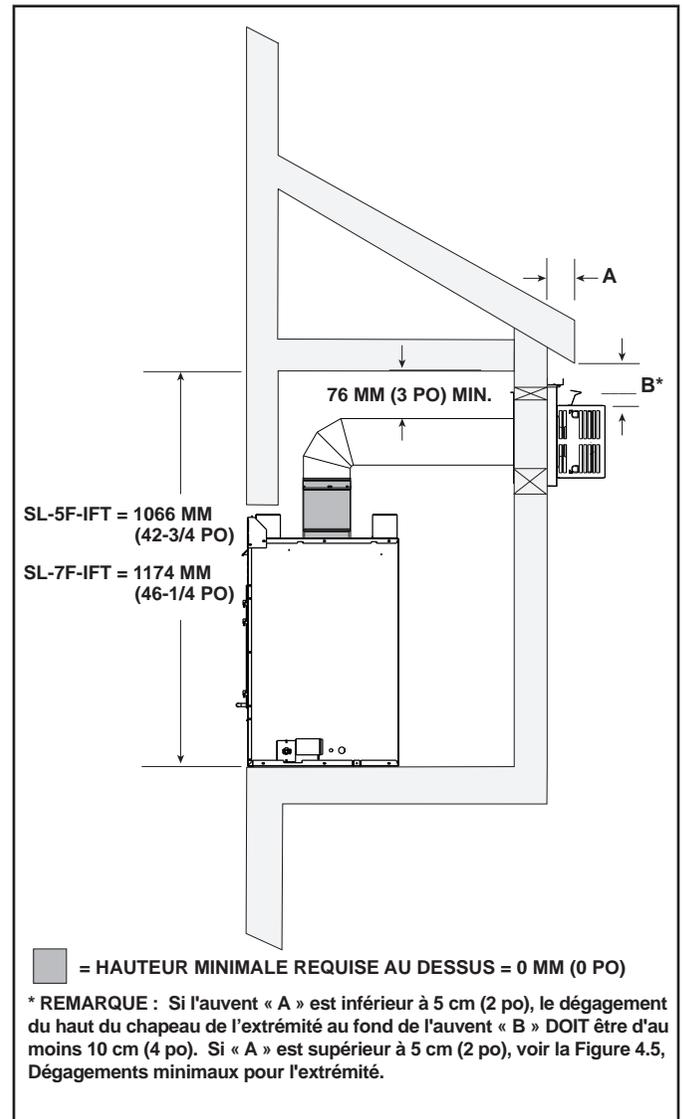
Enchâssure extérieure – Exigences minimales de hauteur
